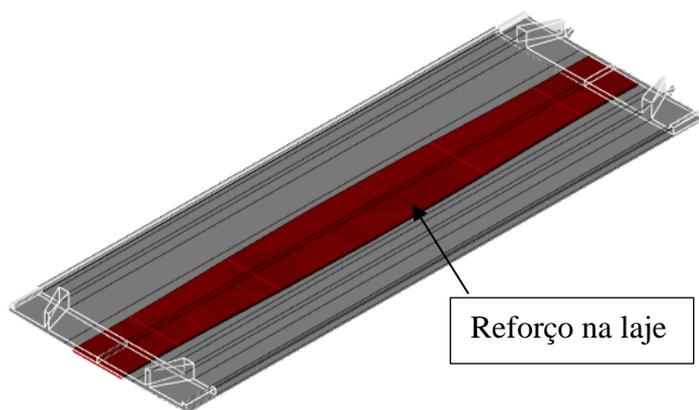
Reforço em concreto projetado que será realizado na parte inferior das lajes.
